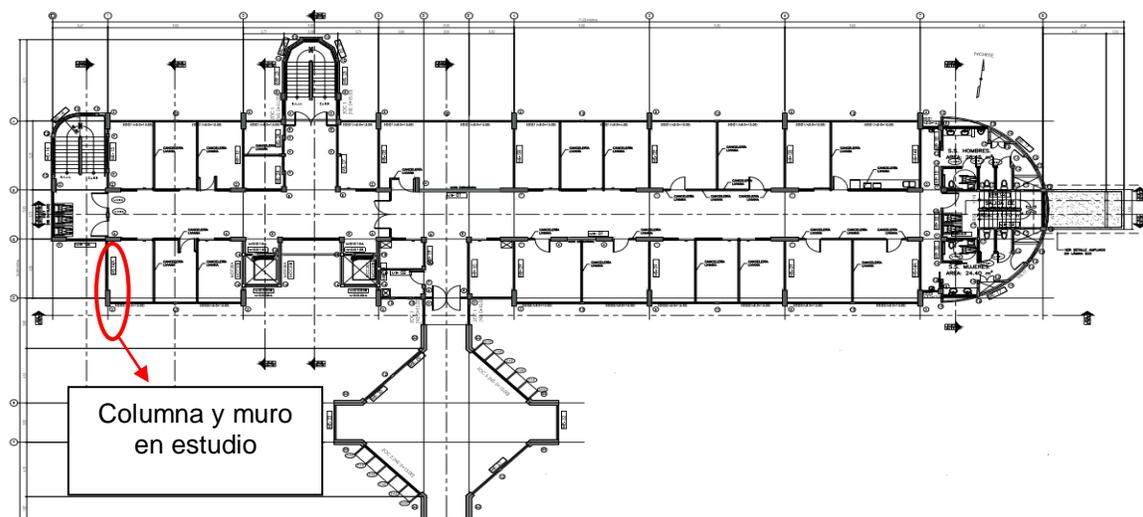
Planta estructural de columnas y muros estructuras edificio TIC'S.
